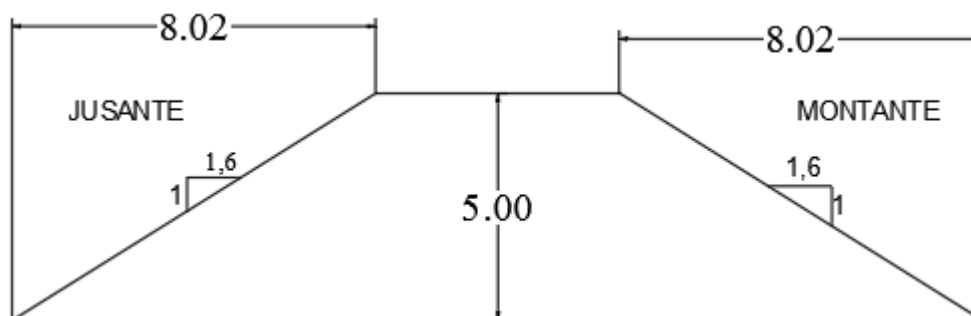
Representação em planta baixa da inclinação do talude de jusante
